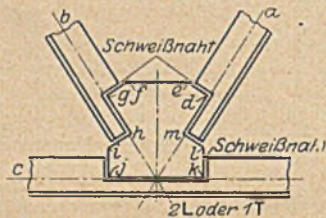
Typische Schweißverbindung für Winkel.
